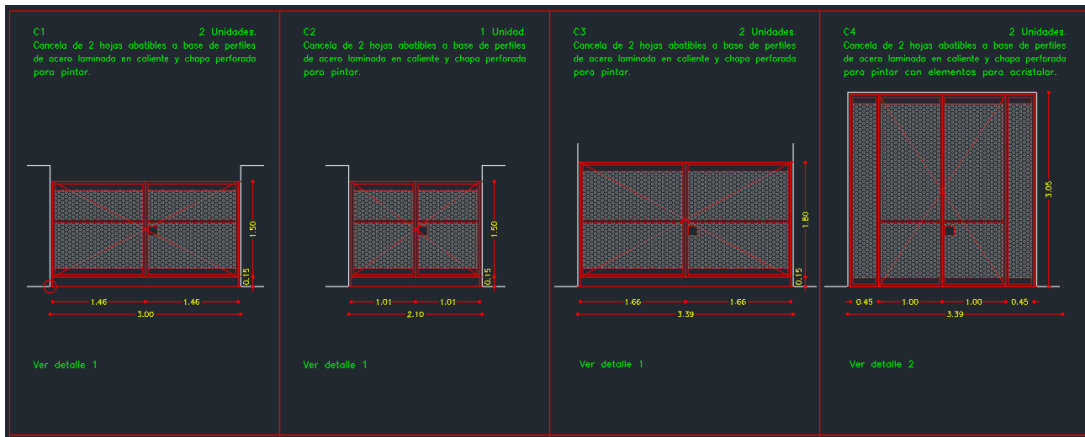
Plano de carpintería metálica con cancelas del proyecto antes de obra
